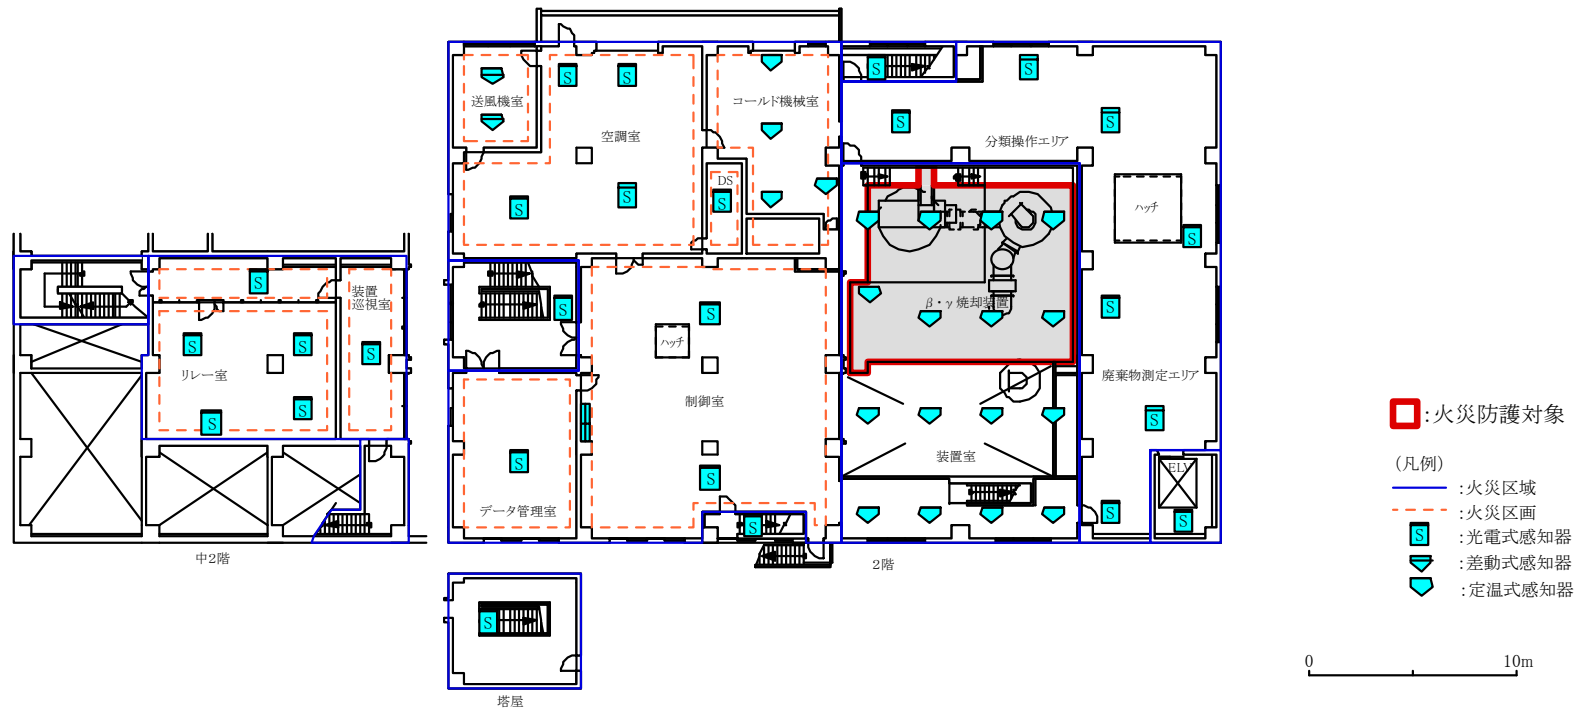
β ・ γ 固体処理棟Ⅲ 2階及び中2階平面図
